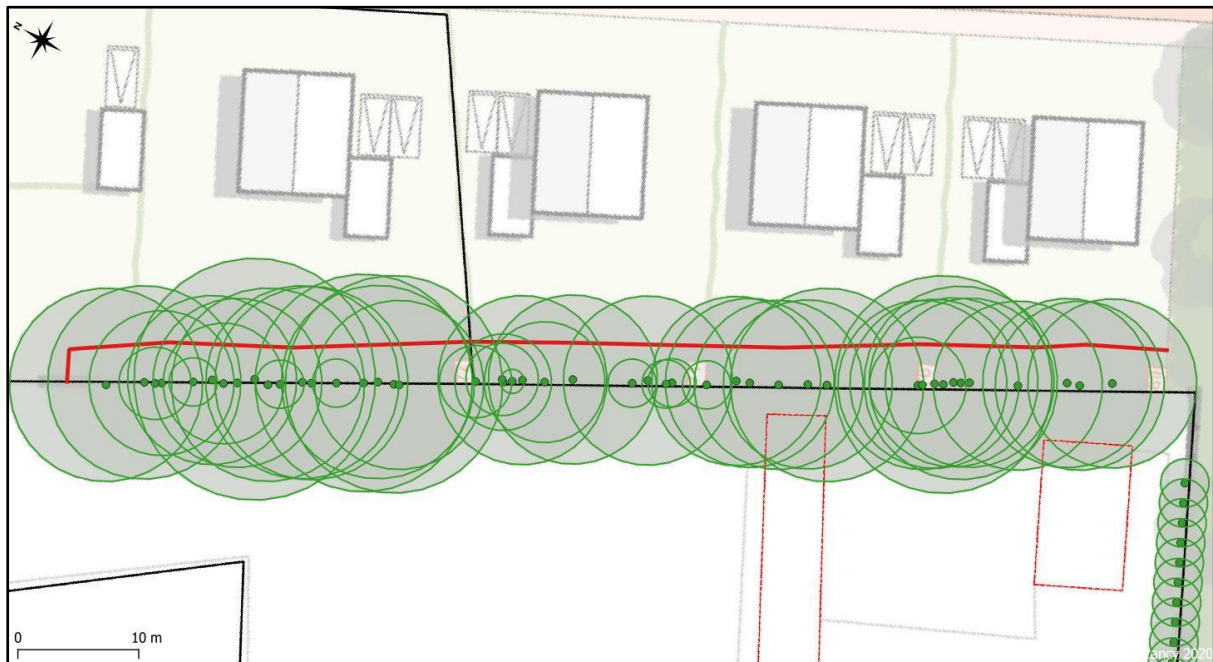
Voorgestelde ligging van het wandelpad aan de noordzijde van de centrale houtwal.
